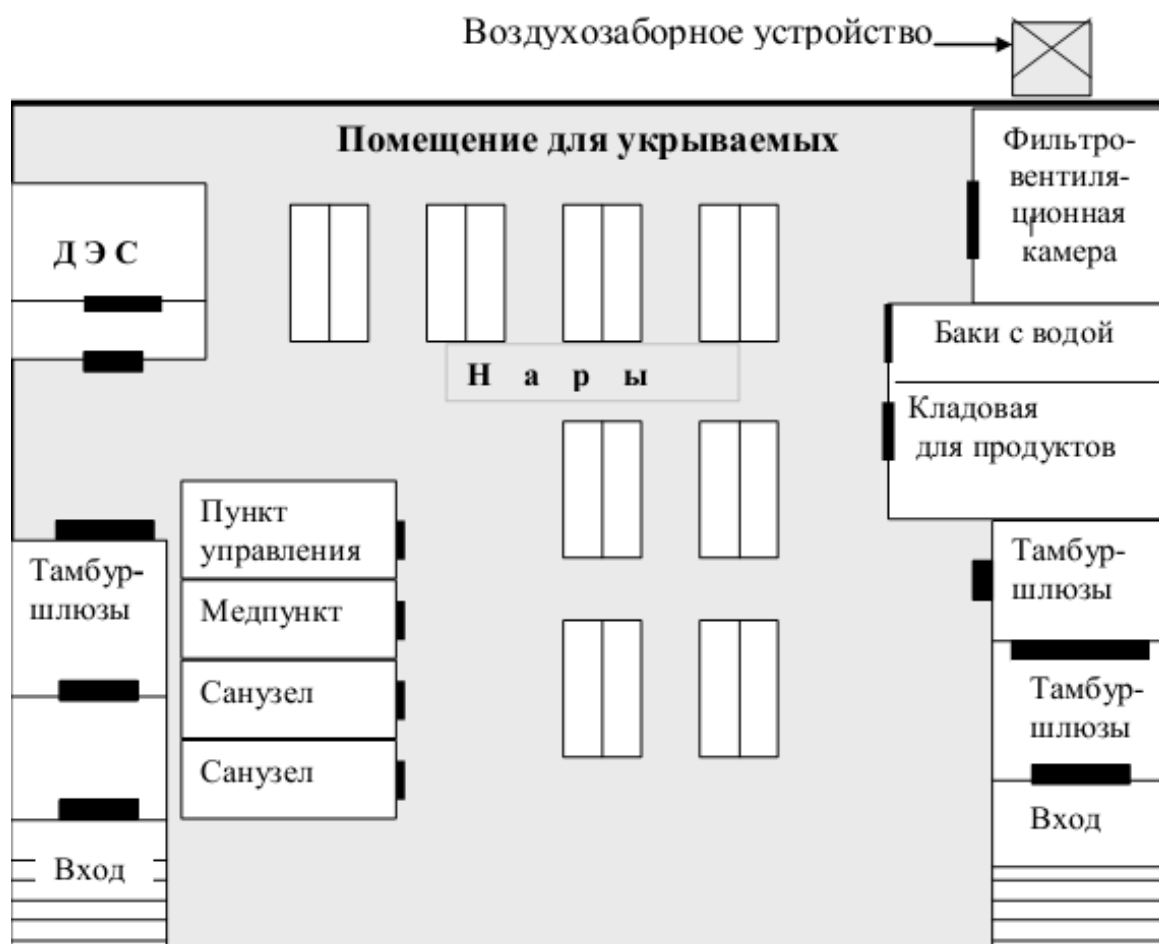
Планировка отдельно стоящего убежища (вариант)
